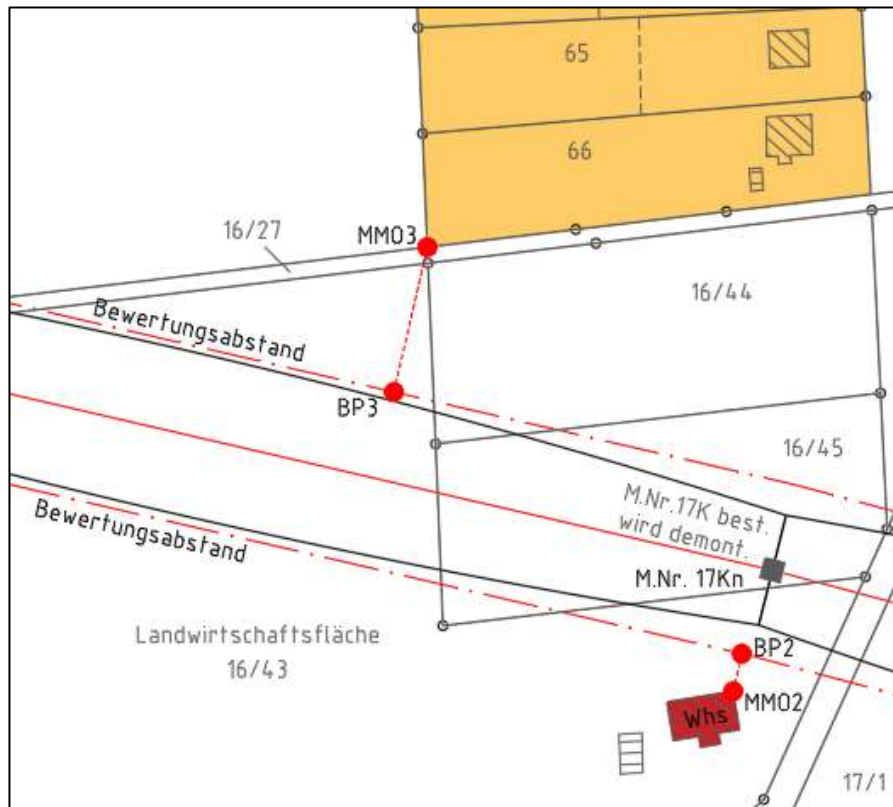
Lageplanausschnitt mit den Minimierungsorten 2 und 3
